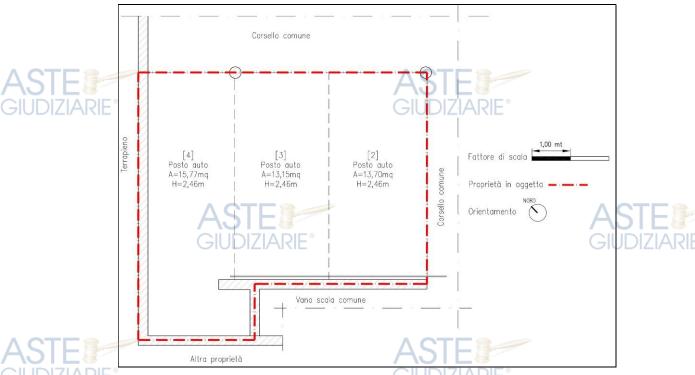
Posti auto piano interrato (sub. 89-90-91)
